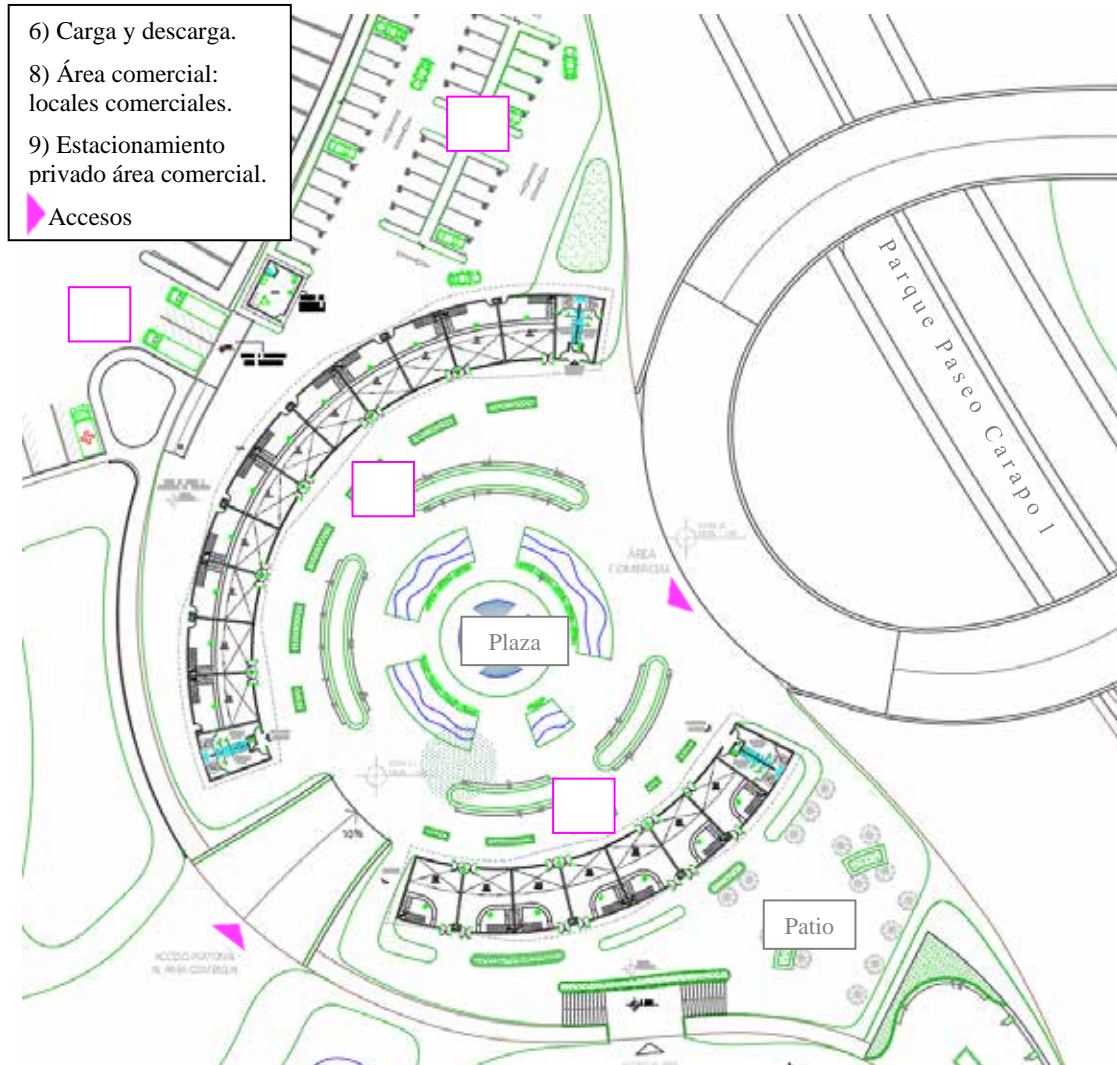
Planta baja conjunto del área comercial. La Autora (2020).
